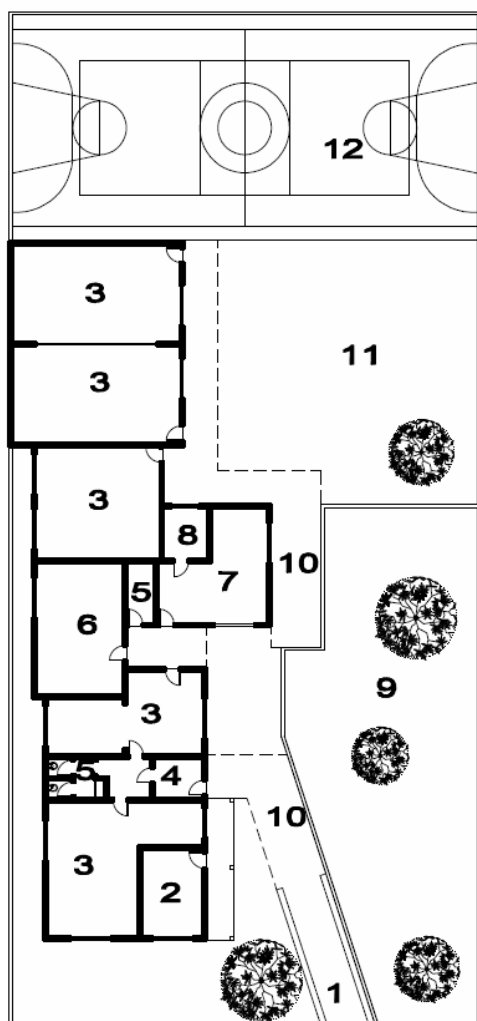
planta baixa do térreo e do 2º pavimento da escola nº. 1(s/ escala).
